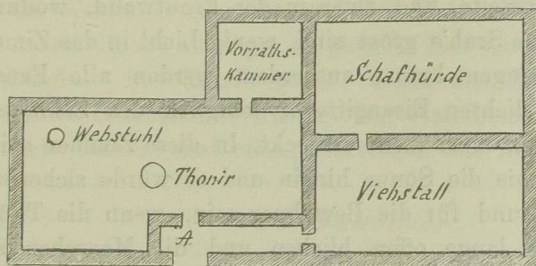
Grundriss eines Hauses aus dem District Alaschkert (Türkisch-Armenien).
